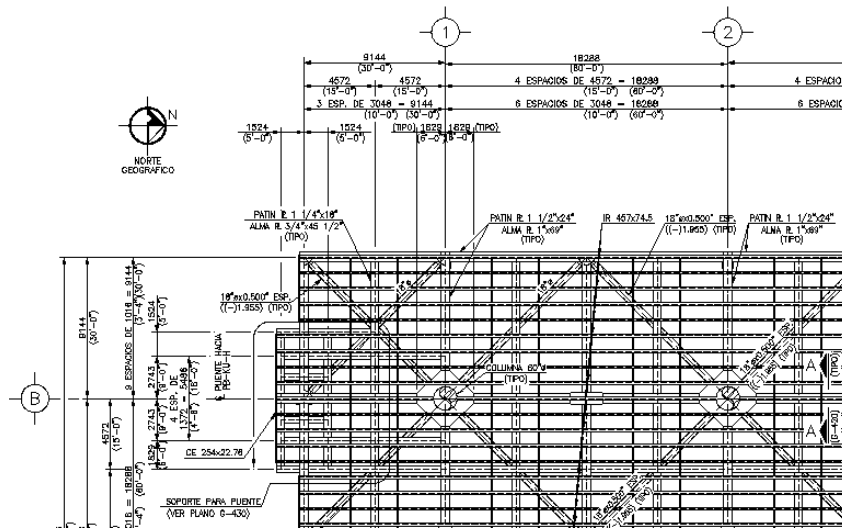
Planta estructural de un sistema de piso de una plataforma (plano).
